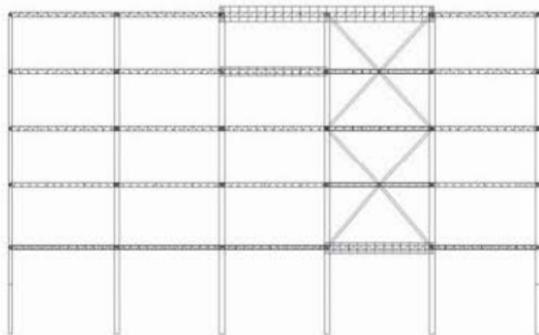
Vue en élévation du bâtiment
